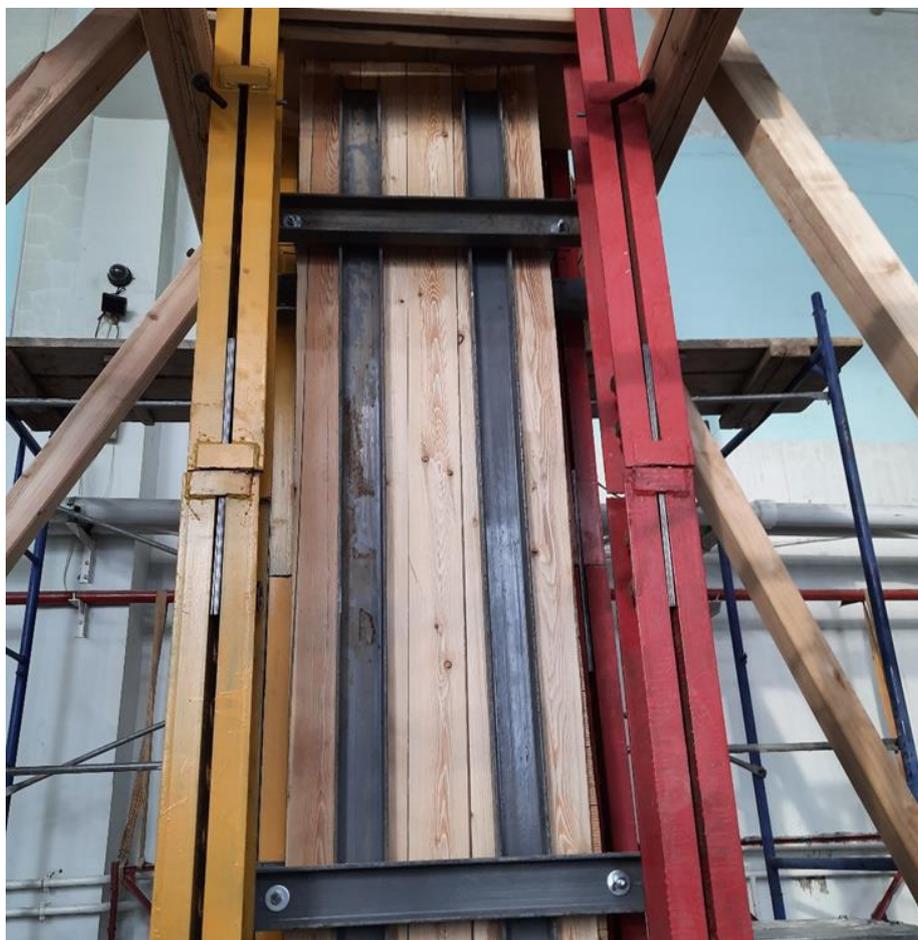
Фрагмент панели на стенде перед испытанием (фасад 1-2)
